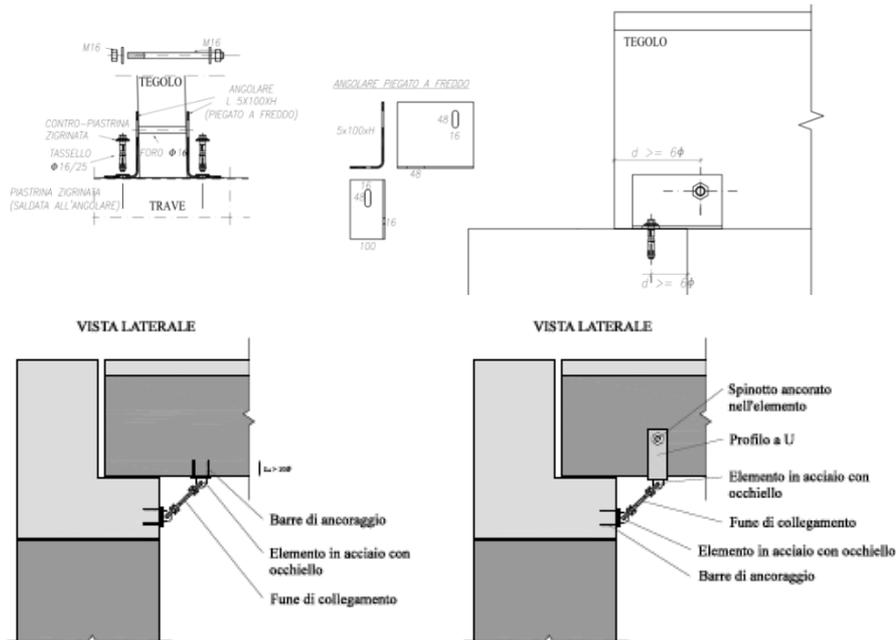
Intervento su connessione trave-pilastro mediante perni e piastre in acciaio
